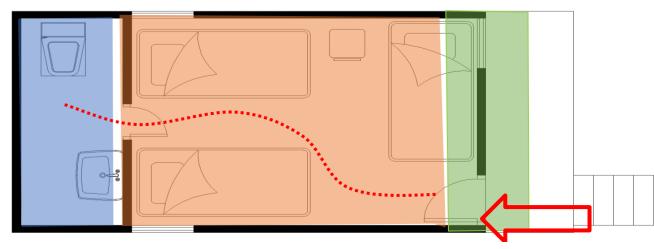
Planta arquitectónica de cabaña de bambú de 30m2 Fuente: Elaboración propia
